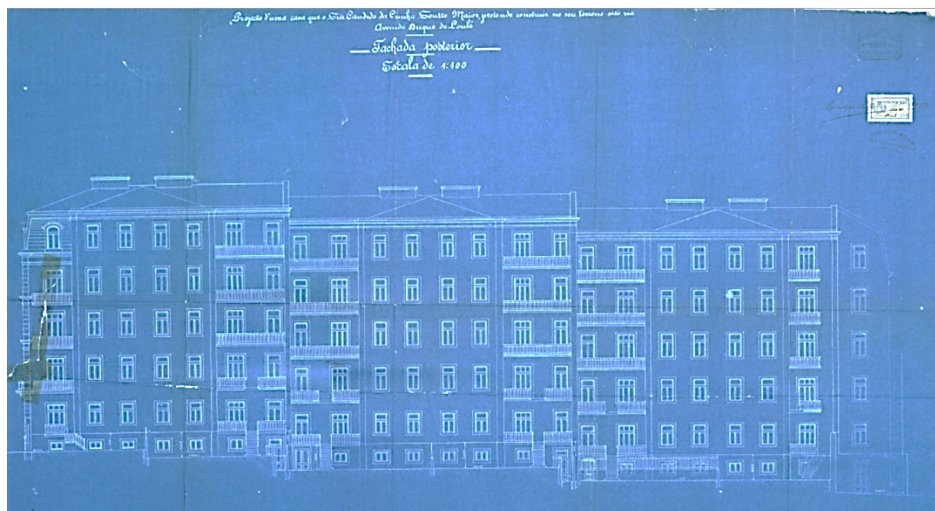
Planta da fachada de tardoz do projeto inicial dos edifícios n.º 86, 90 e 94 da Avenida Duque de Loulé [38].
